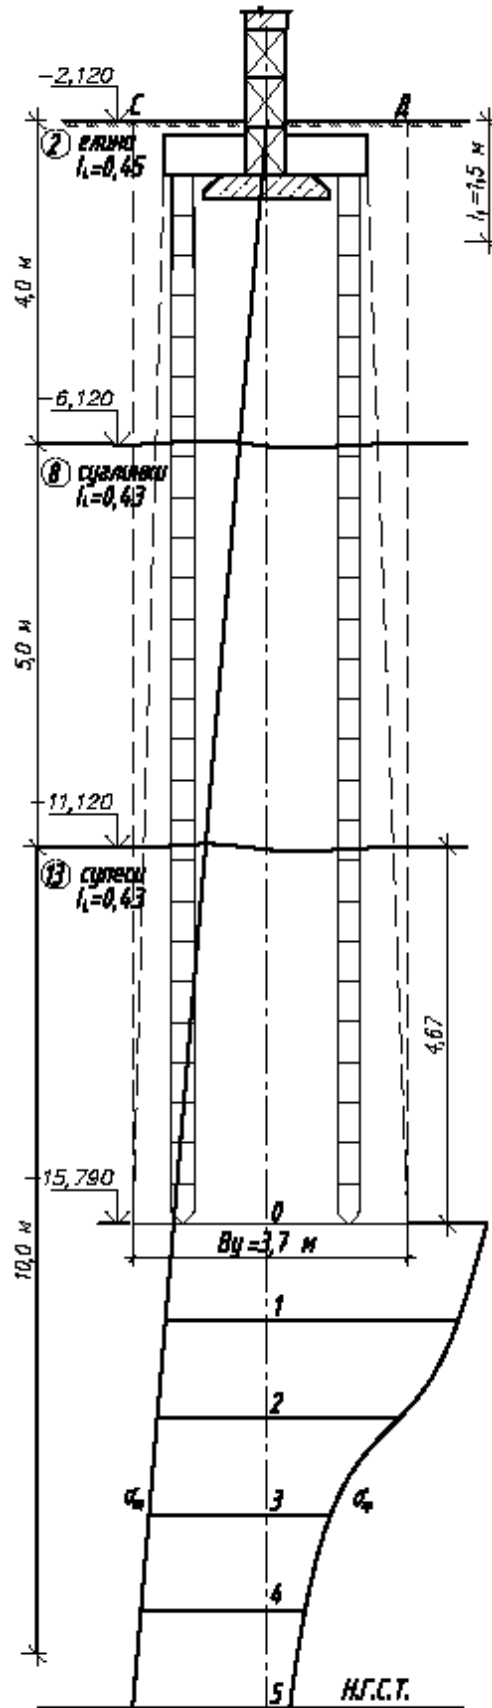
Схема расчета осадки фундамента на естественном
